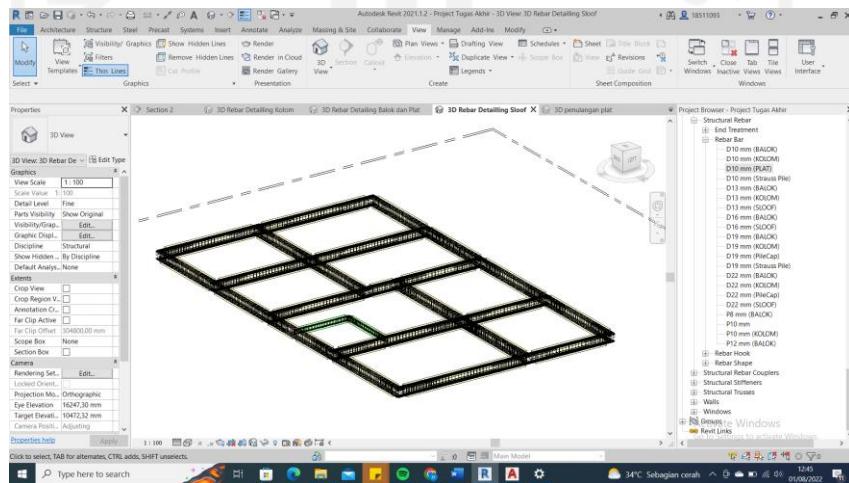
22 Tampilan Lokasi Potongan untuk Membuat Sloof dan Balok
